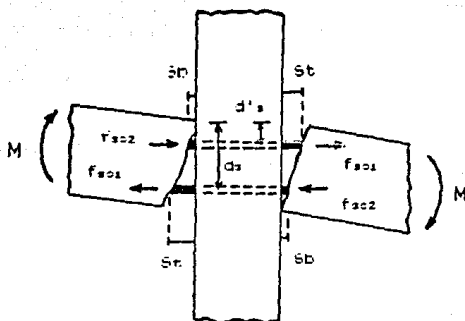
Deslizamiento del refuerzo en el interior de la junta Viga-columna.
